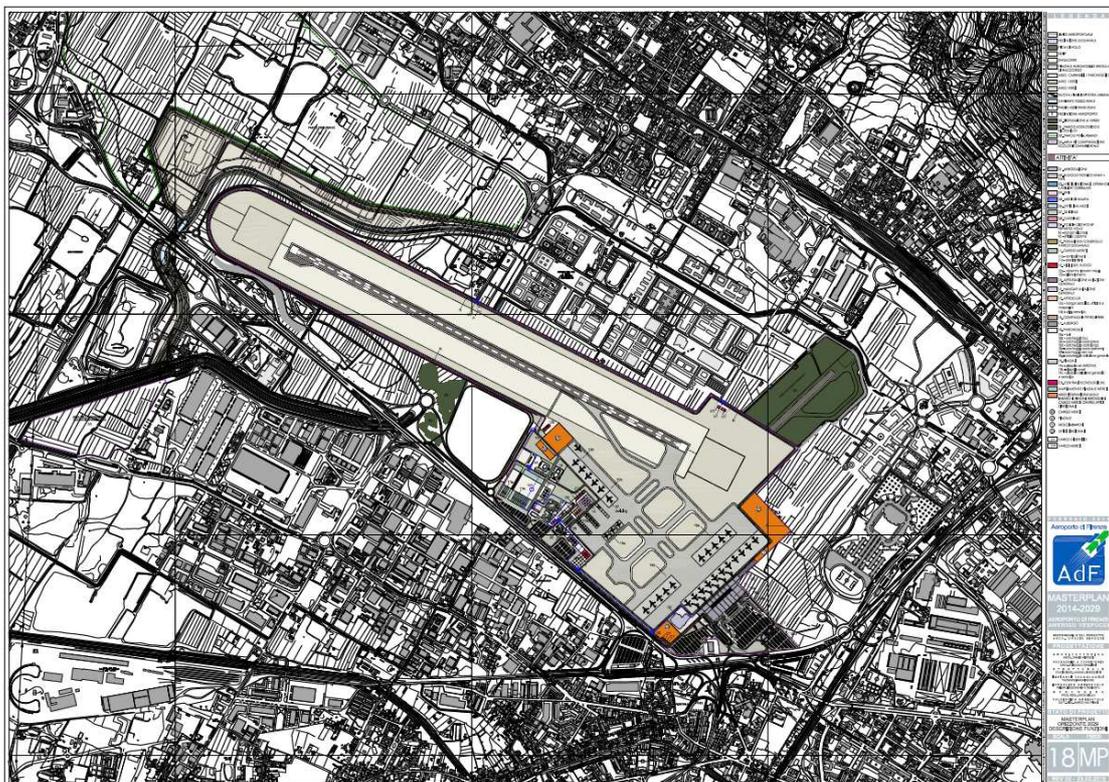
La nuova pista 12/30 (Tavola Masterplan-Orizzonte 2029-Descrizione funzioni)
